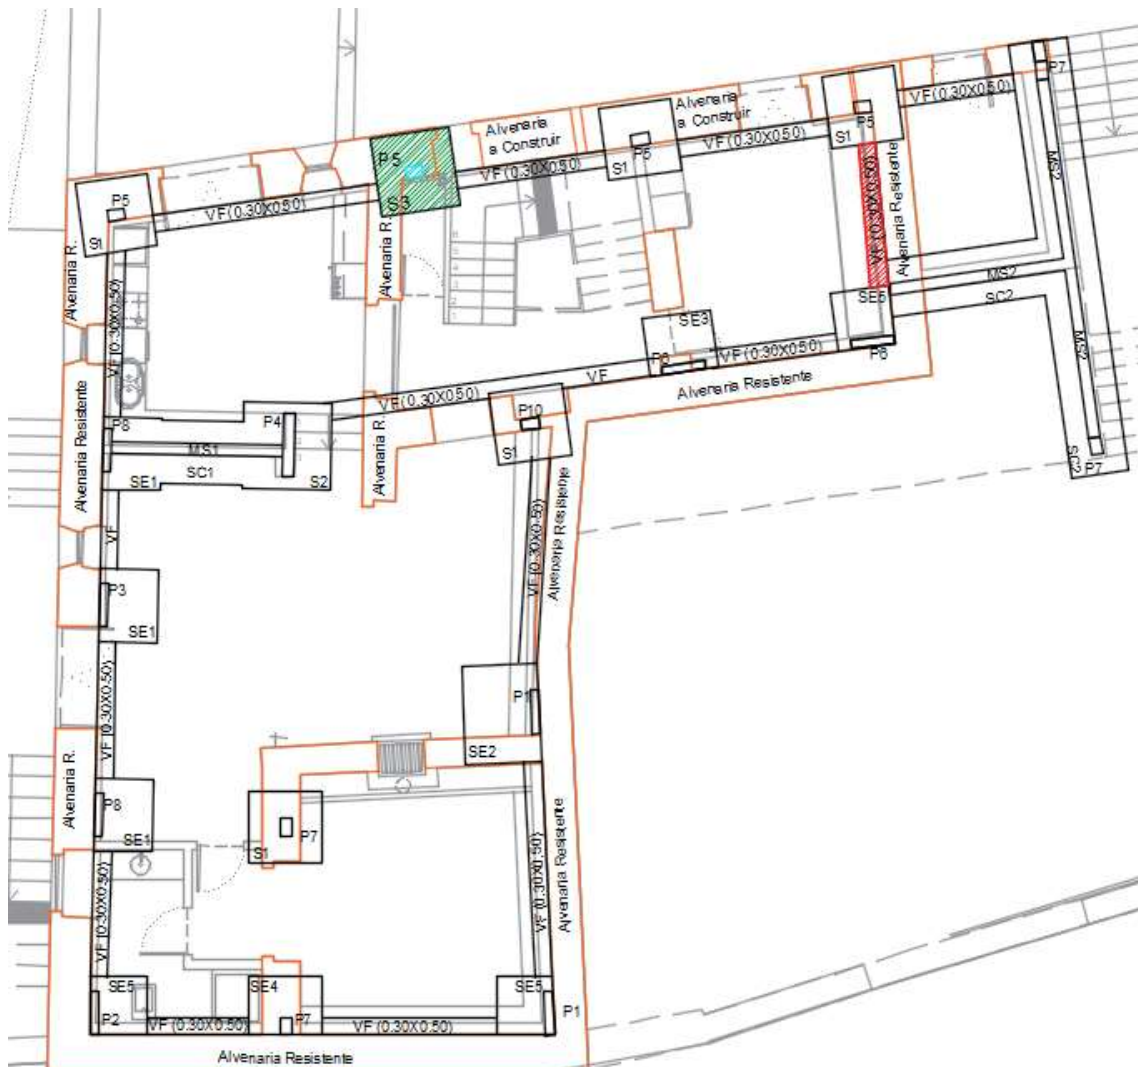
Planta de fundações da cave, evidenciando os elementos analisados (sem escala).
